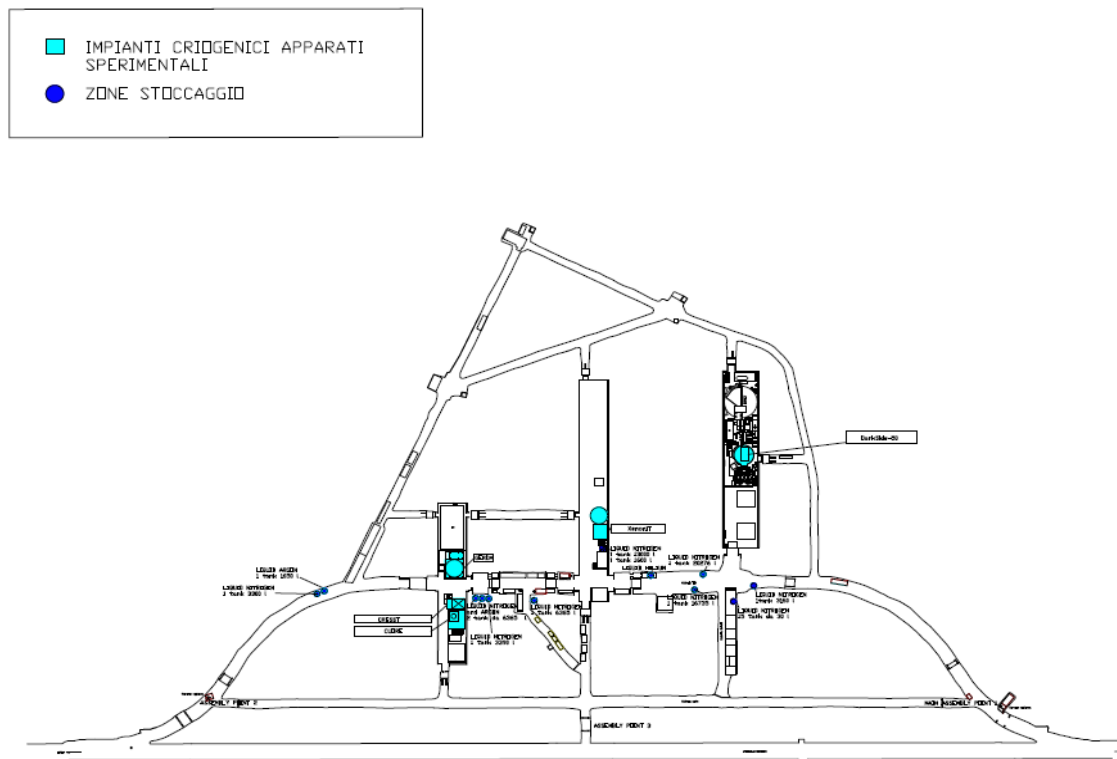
Planimetria con ubicazione stoccaggi dei gas inerti nei Laboratori sotterranei
